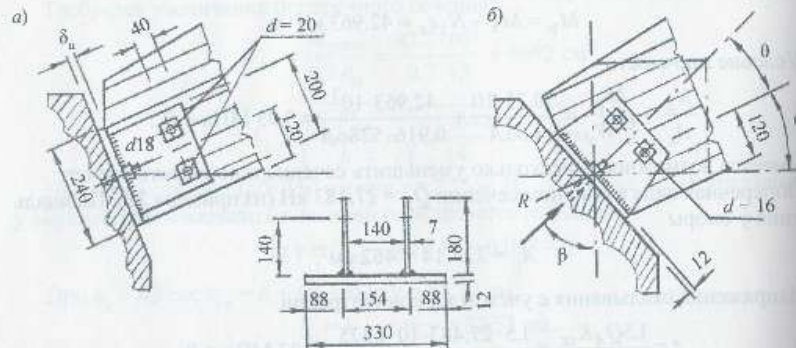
Конструктивные решения узлов арки из прямолинейных элементов: а – нормальная площадка сжимающего усилия на опорную площадку; б – расположение опорной площадки с уменьшенным сдвигающего усилия в ее плоскости
